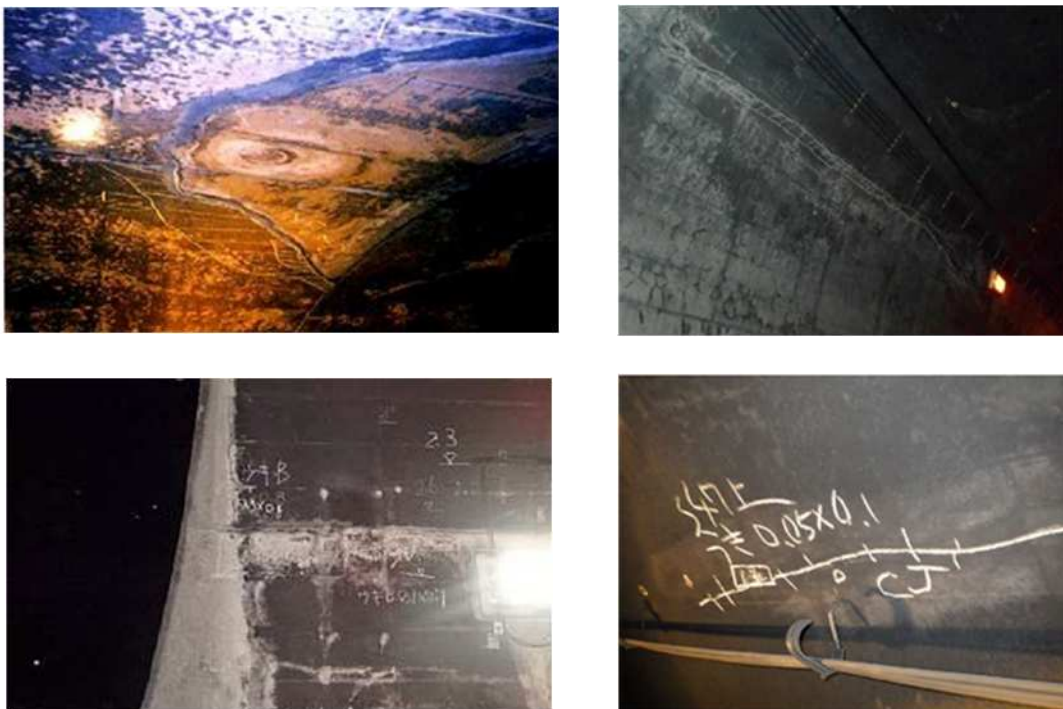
コールドジョイント付近に発生したひび割れの例 (P.40 文献<sup>2)</sup>参照)
